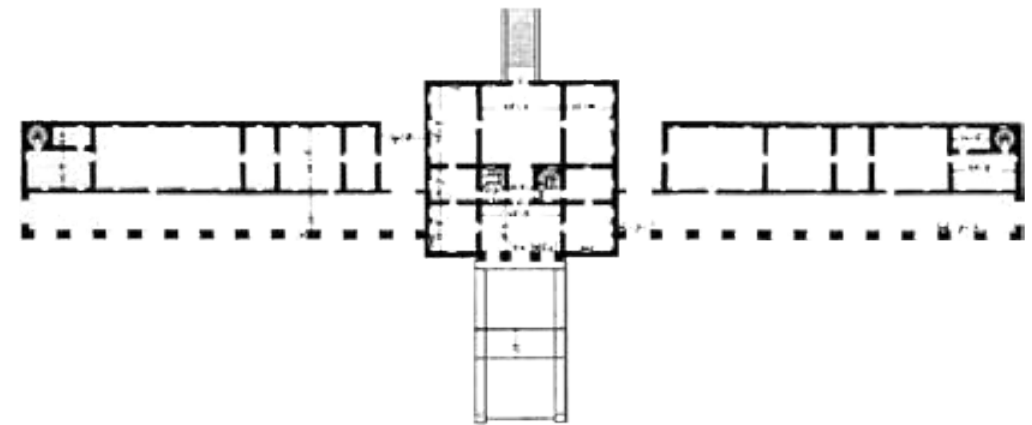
Grundriss Villa Emo | 0 | 20m
